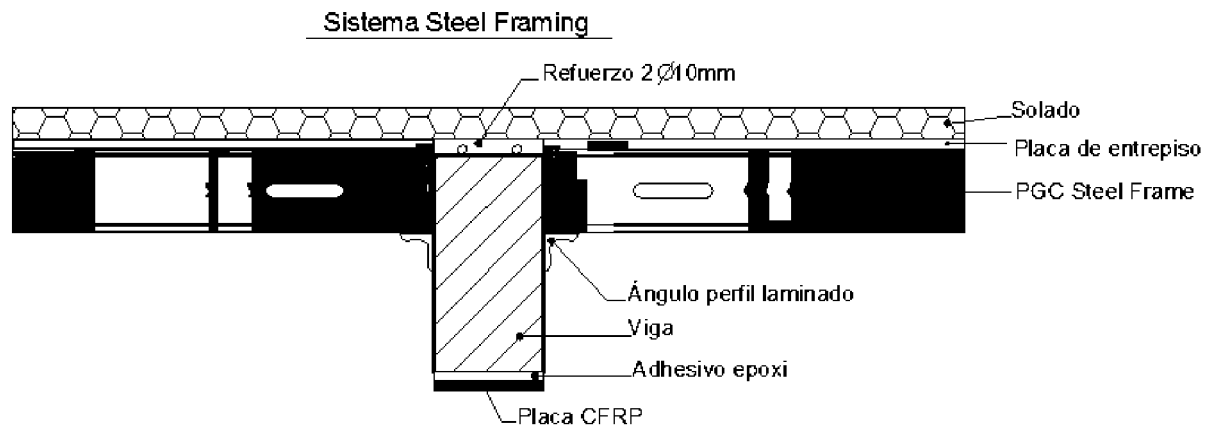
Sección transversal del Sistema Steel Framing con los refuerzos. Fuente: Sánchez Avalos y Soto (2016).
